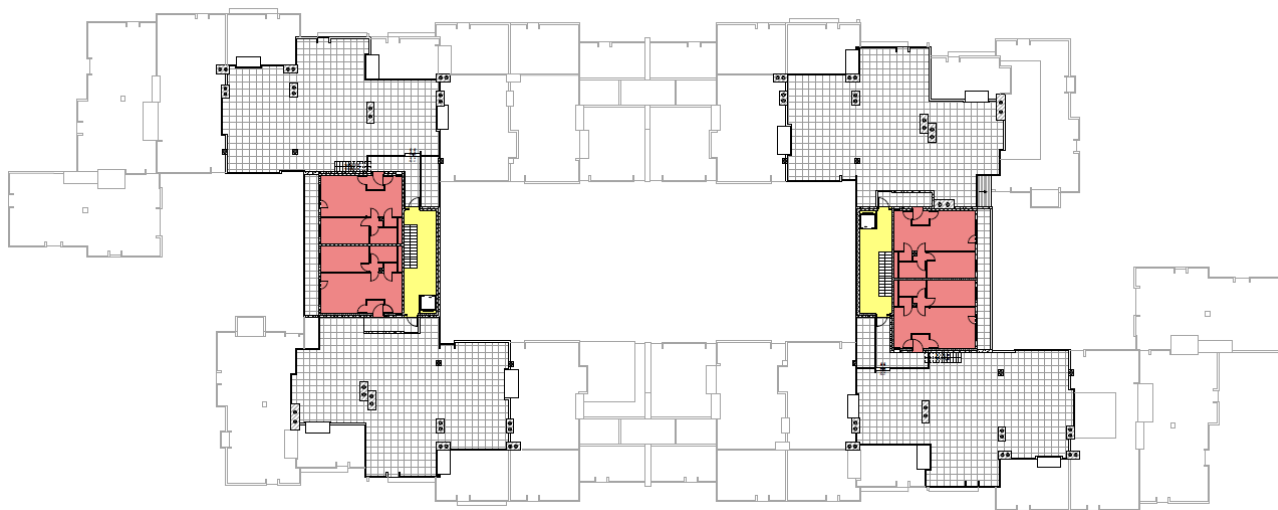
Projektna dokumentacija – shema zona – 3. kat
